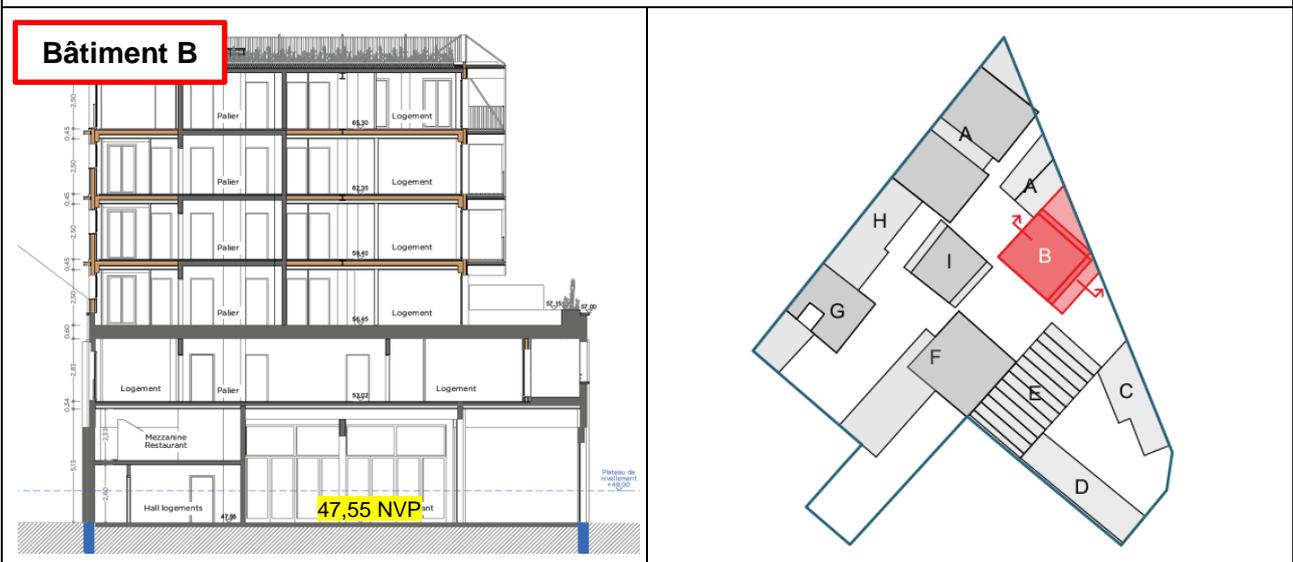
Extrait du plan de coupe B-B' du bâtiment B, daté du 17/11/2023
